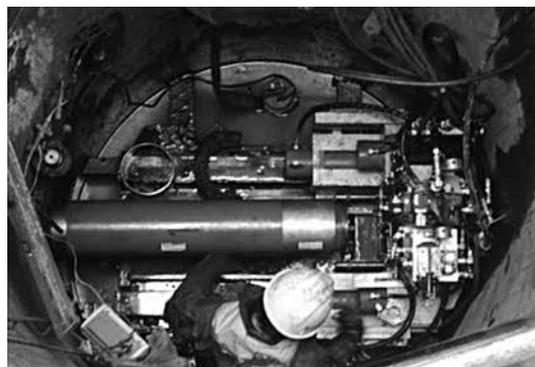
ケーシング立坑での施工状況<sup>1)</sup>
